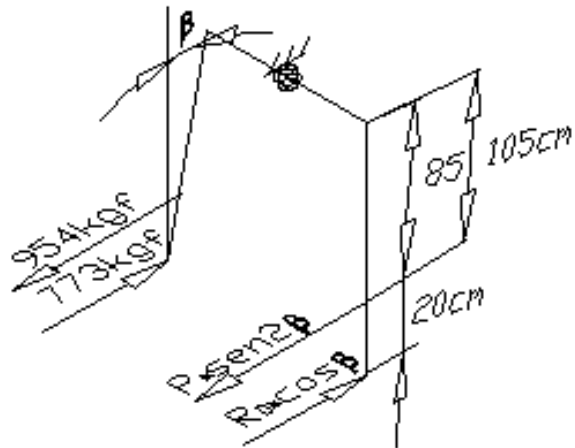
Carga en el plano perpendicular al plano del pórtico.
